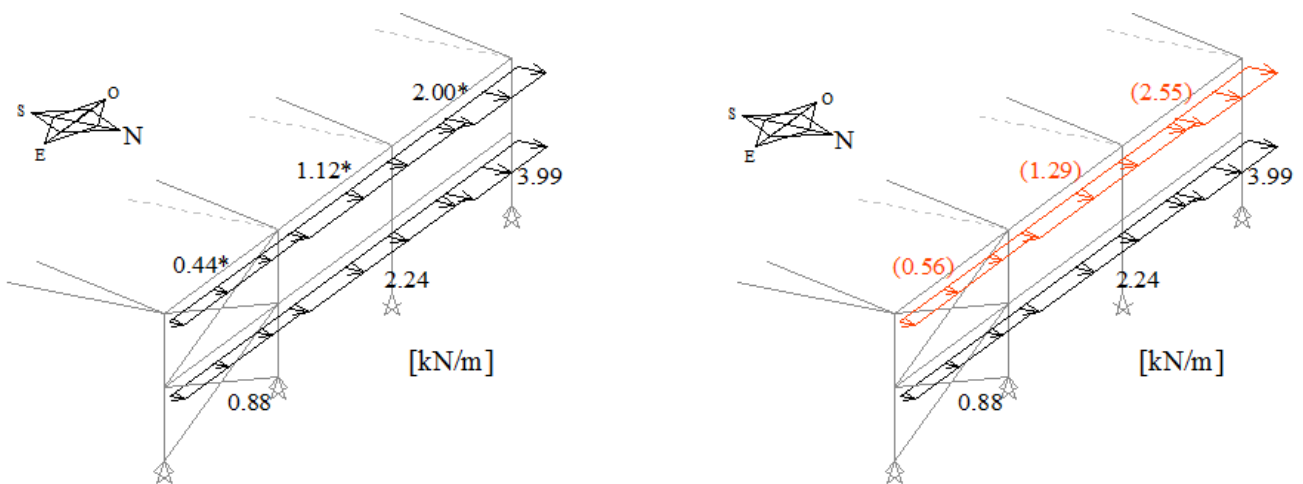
Vento W2 na fachada orientada a Norte na situação 2 (EC1.1.4)
